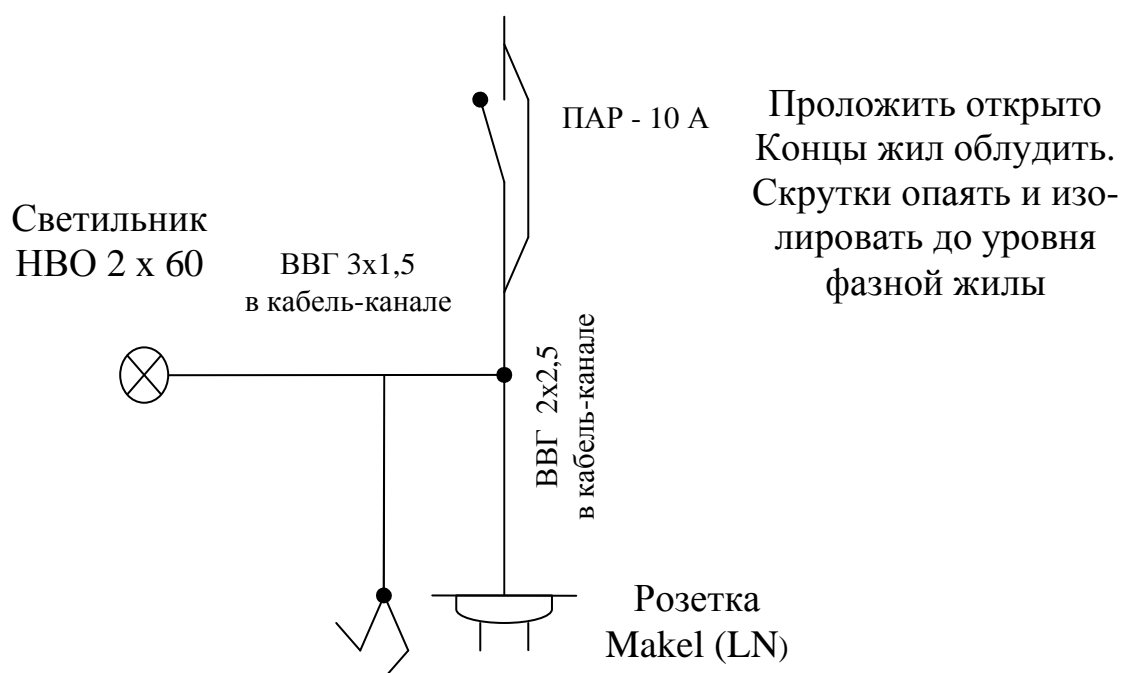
Монтажная схема участка проводки в кабель-канале
